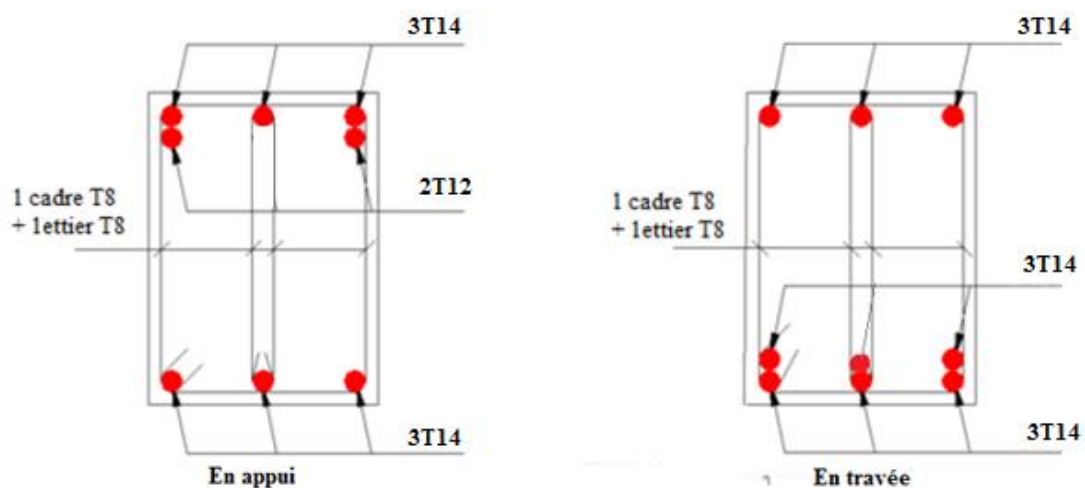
Ferrailage des Poutres non porteuses de 4^{ème}, 5^{ème} et 6^{ème} étages.
